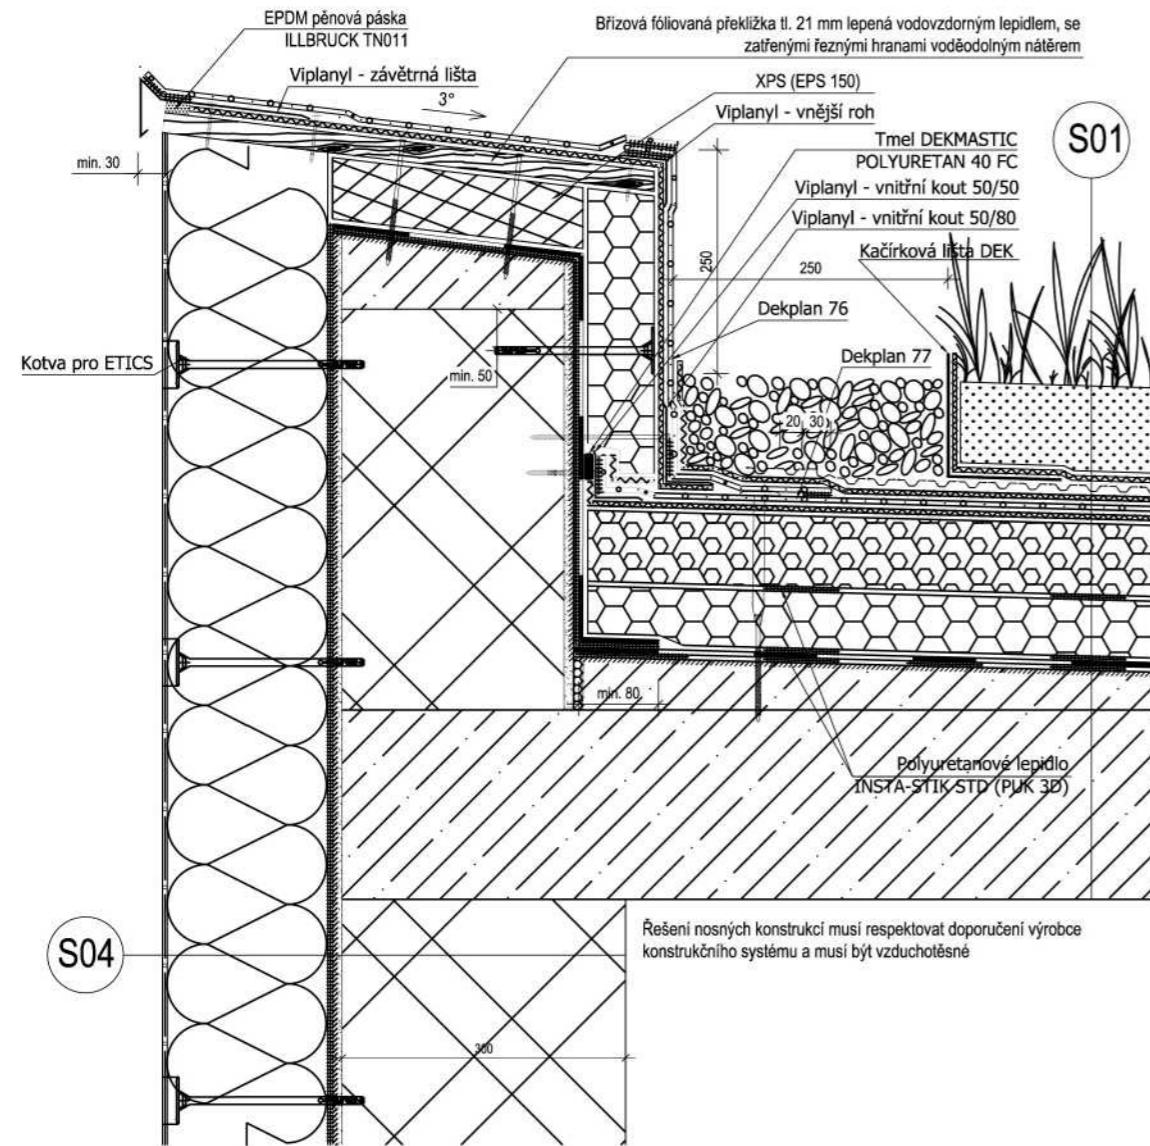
DETAIL ŘEŠENÍ FASÁDNÍHO OBKLADU
